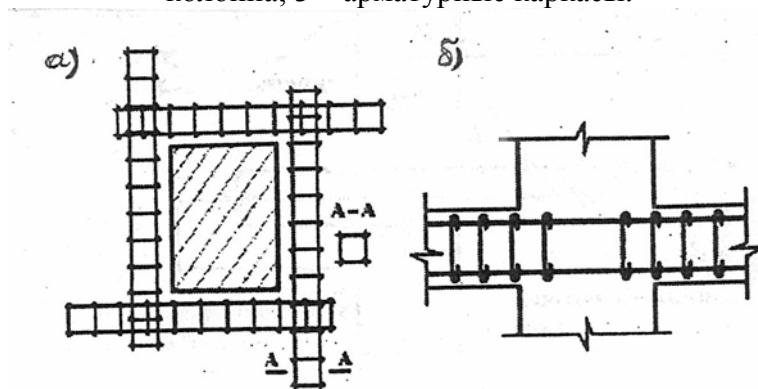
Различные варианты поперечного армирования зоны опирания [8]
